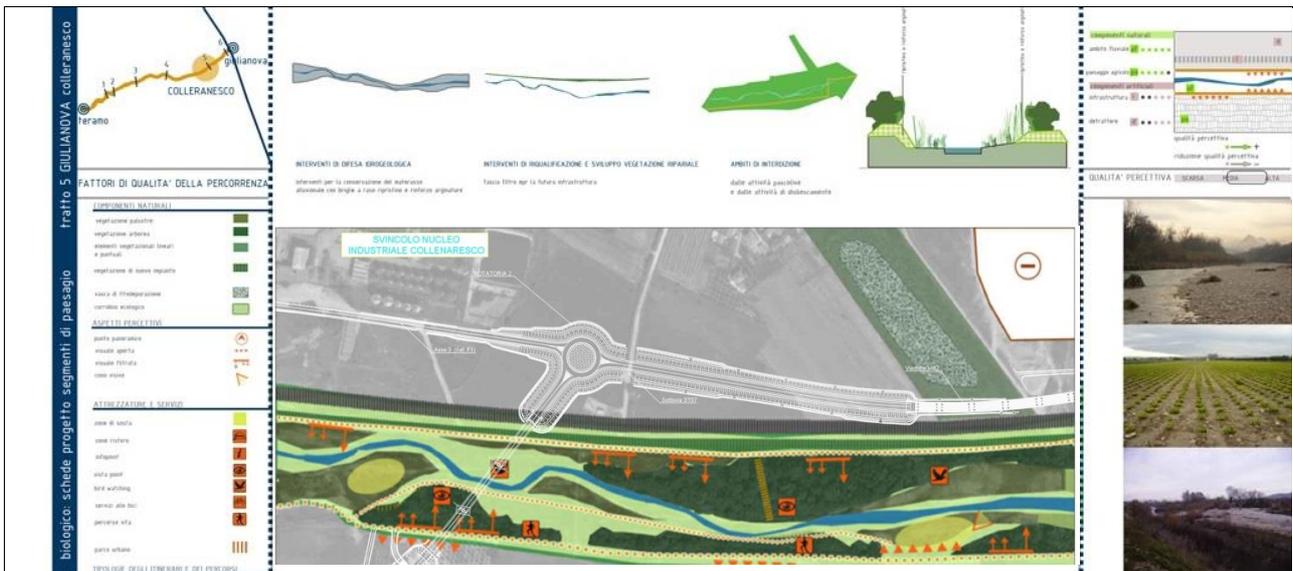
Attraversamento fiume Tordino sovrapposizione intervento di progetto su Tav. 3.D.4 del Piano
